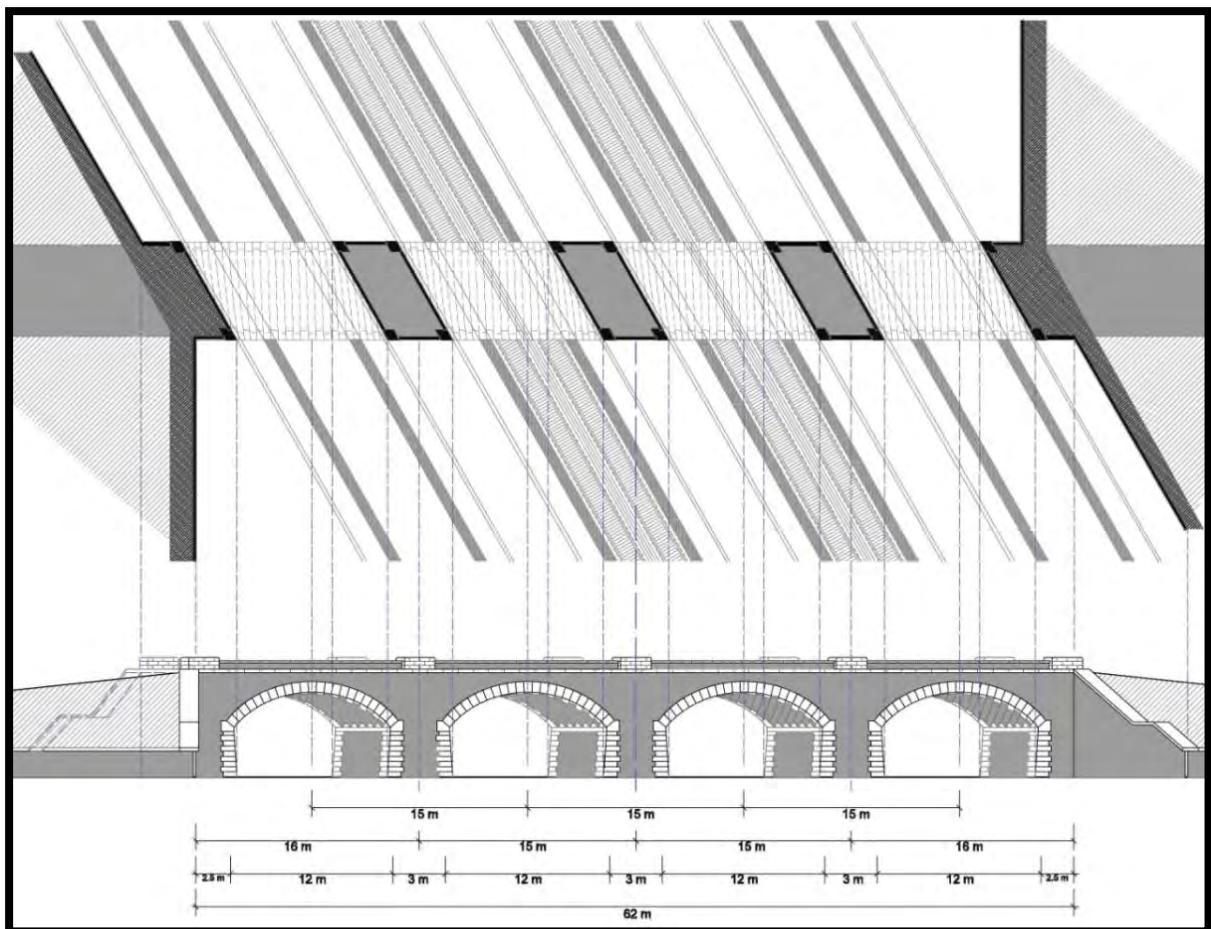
Pianta e Prospetto (Scala 1:500).
